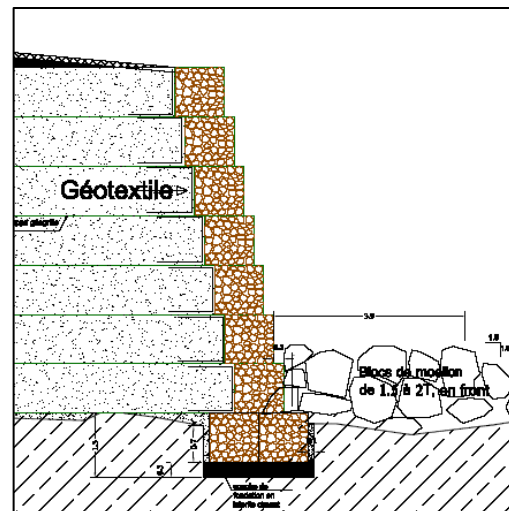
Profil type de l'ouvrage de protection des berges projeté-Kayes
